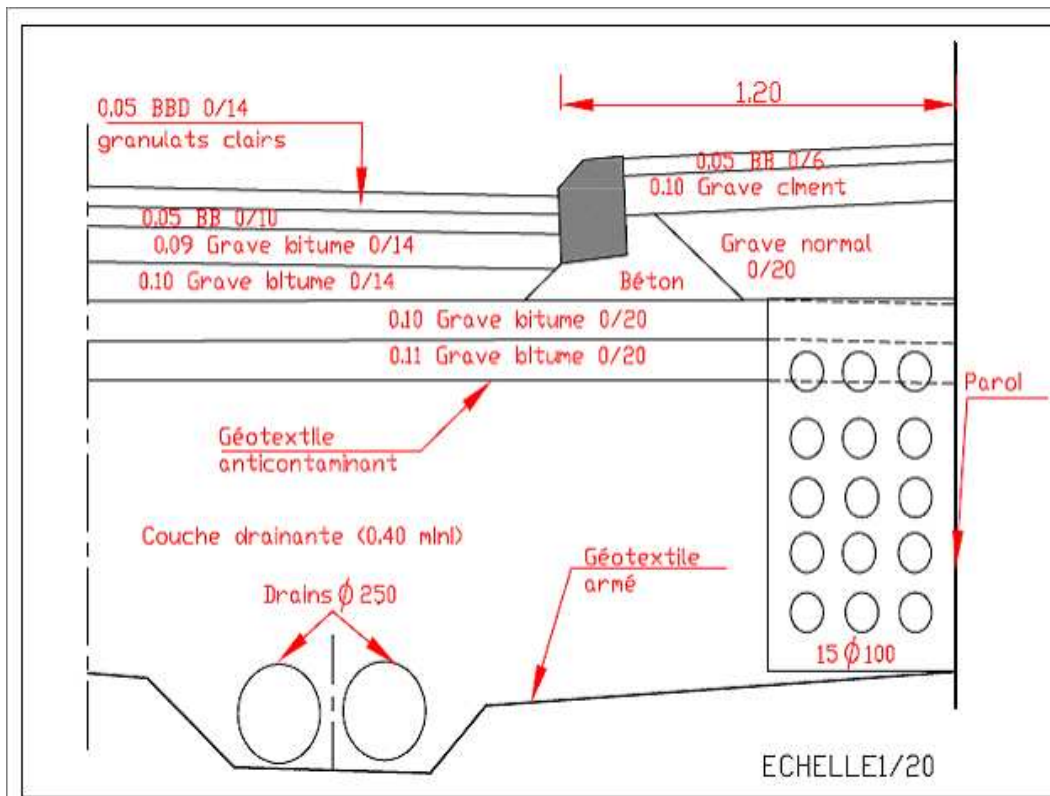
Coupe schématique pour la réalisation d'une chaussée drainante.
